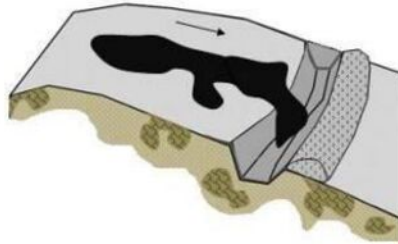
Trinchera de contención impermeabilizada, construida en el recorrido esperado del derrame
